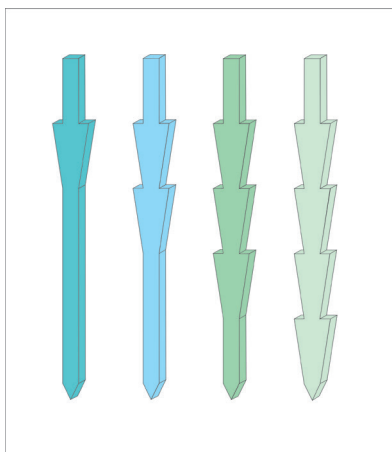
Схемы свай с плоскими пирамидальными уширениями
